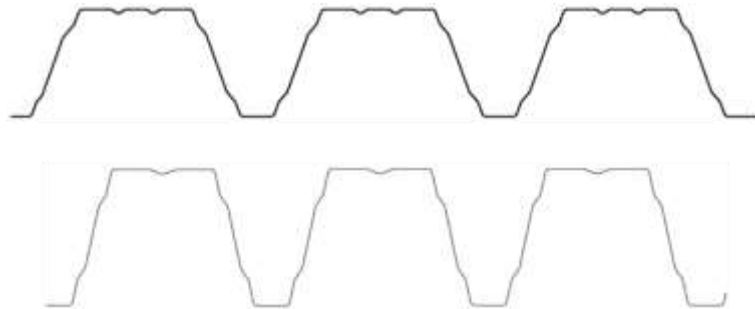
Geometria tipica delle lamiere profilate in acciaio.
